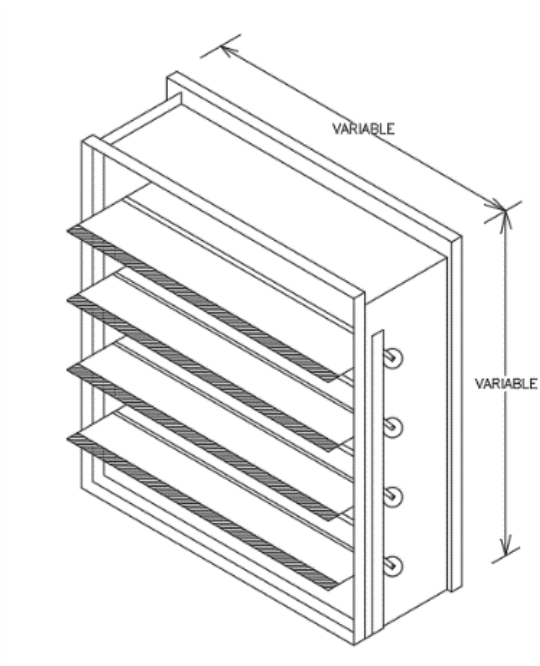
Esquema de dámper de gravedad. Elaborado en AutoCAD.
